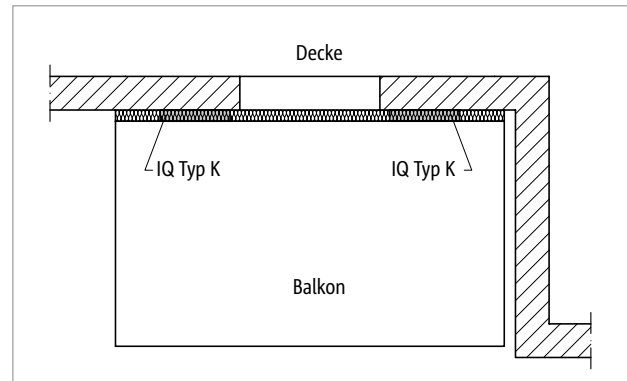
Schöck Isokorb® IQ Typ K-A/B: Balkon bei Fassadenversprung
